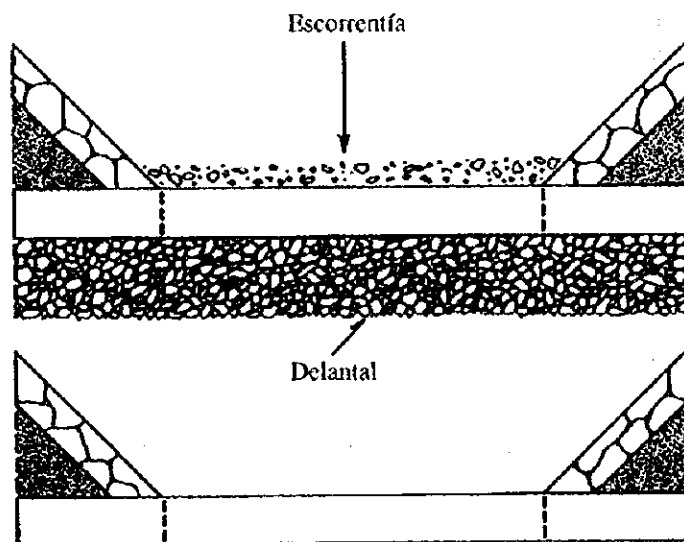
Planta de la Presa de Mampostería para el Control de Azolves
